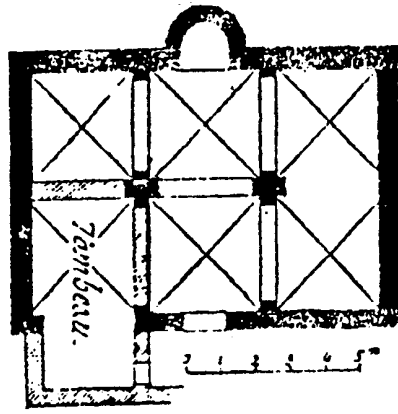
مسقط أفقي لمسجد ام الوليد (عن : Creswell)
